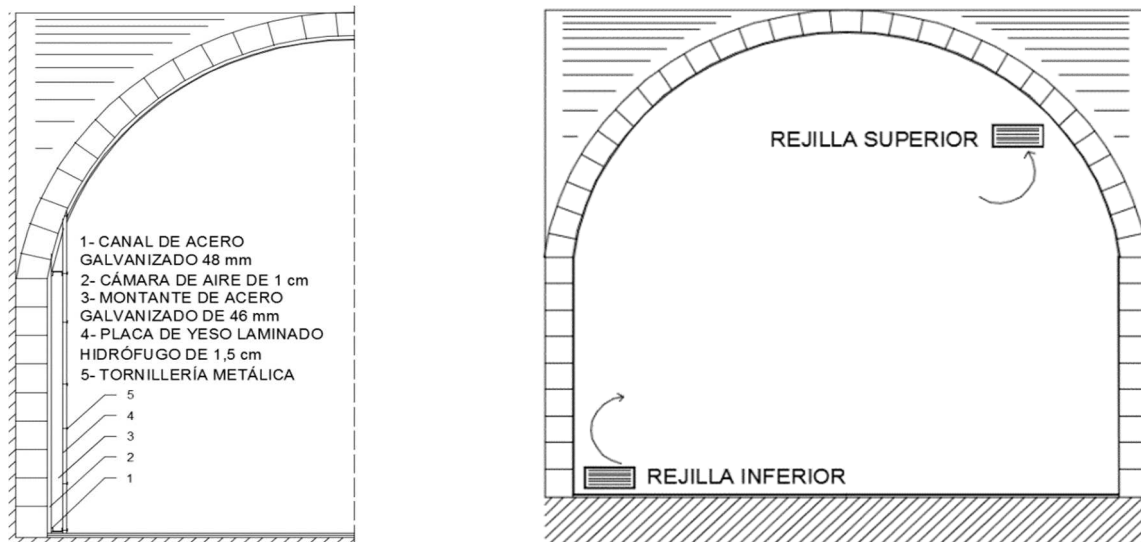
Imagen izquierda - Sección trasdosado placa de yeso laminado. Imagen derecha - Aperturas para la aireación del trasdosado de placa de yeso. Fuente: Elaboración propia.
